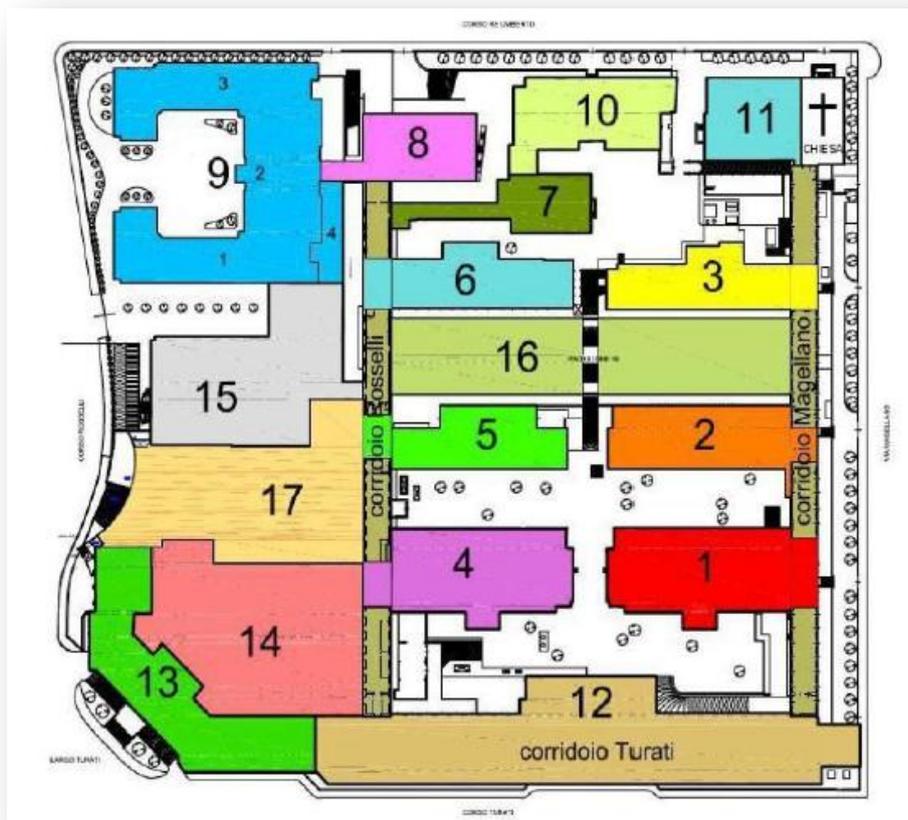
P.E.I. planimetria generale indicante la suddivisione in padiglioni
